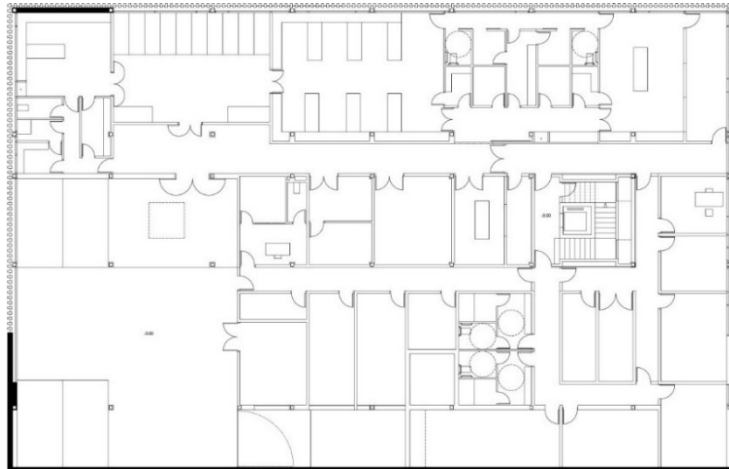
Planta baja Inst. medicina legal (Granada-España)
